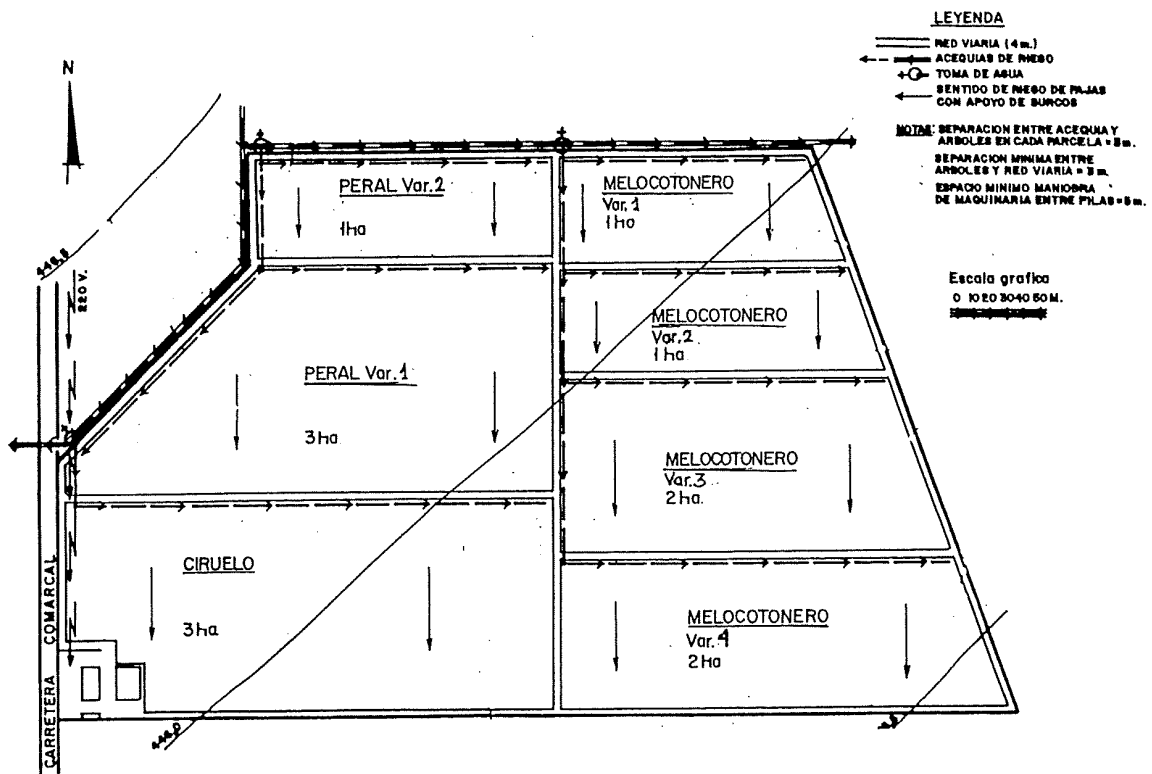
Alternativas de diseño en una plantación con riego por gravedad.
